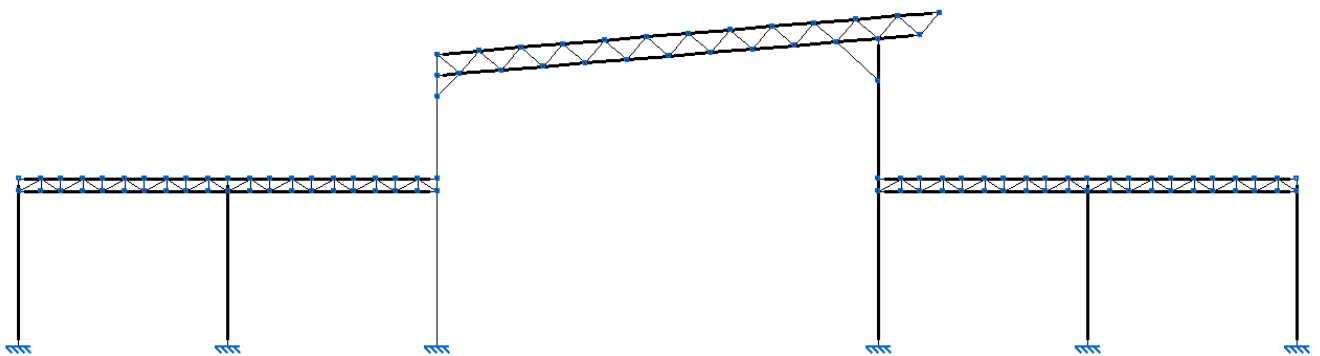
Geometría Modelo CYPE 3D – barras Vista Sur
